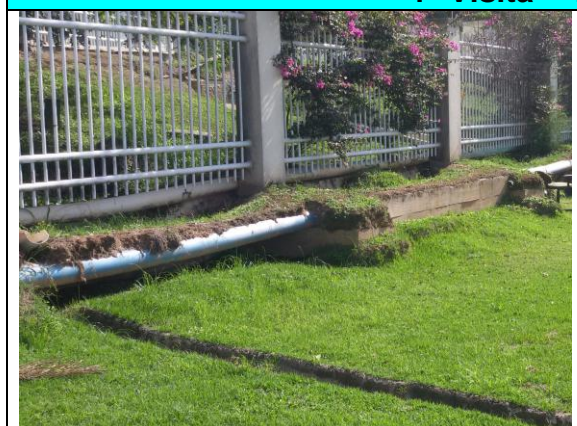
Tubulações expostas devido a elevado adensamento do solo
